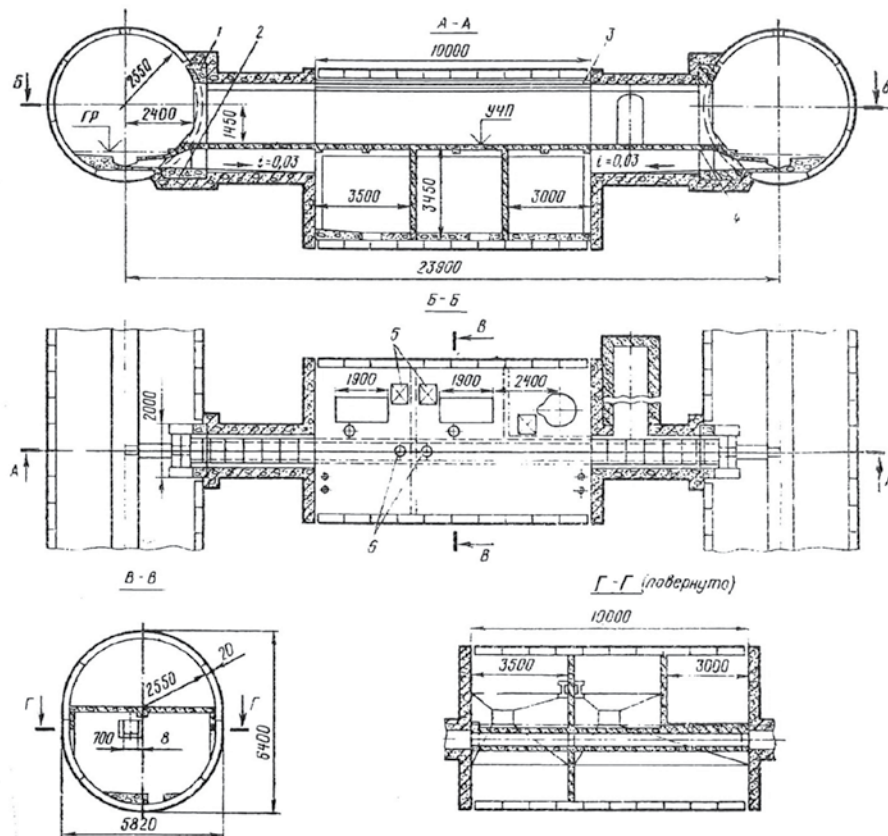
Основная водоотливная установка на линиях метрополитена: 1 — железобетонная рама; 2 — металлическая гидроизоляция; 3 — монтажная балка; 4 — решетчатая дверь; 5 — люки 700 × 700 мм; 6 — люки диаметром 420 мм; 7 — ходок к буровой скважине
